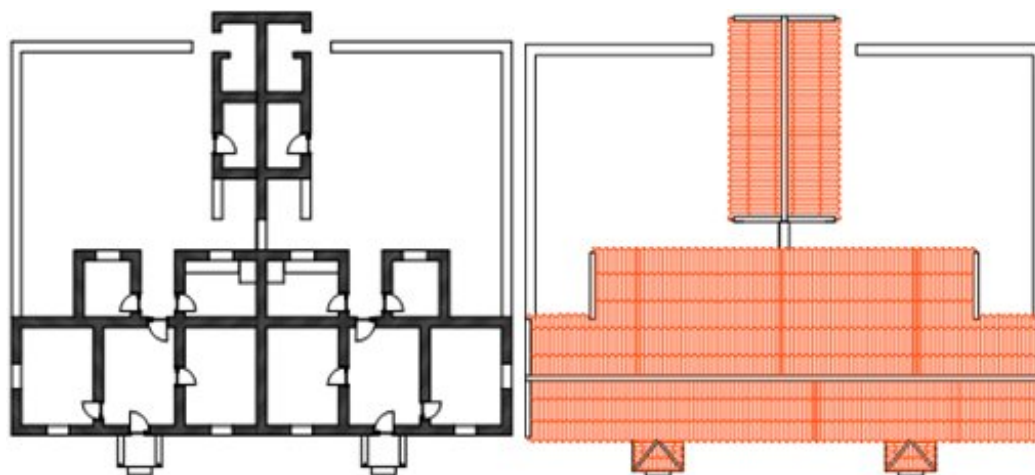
Planta existente e Planta cobertura moradia de um guarda PSP de Angola
